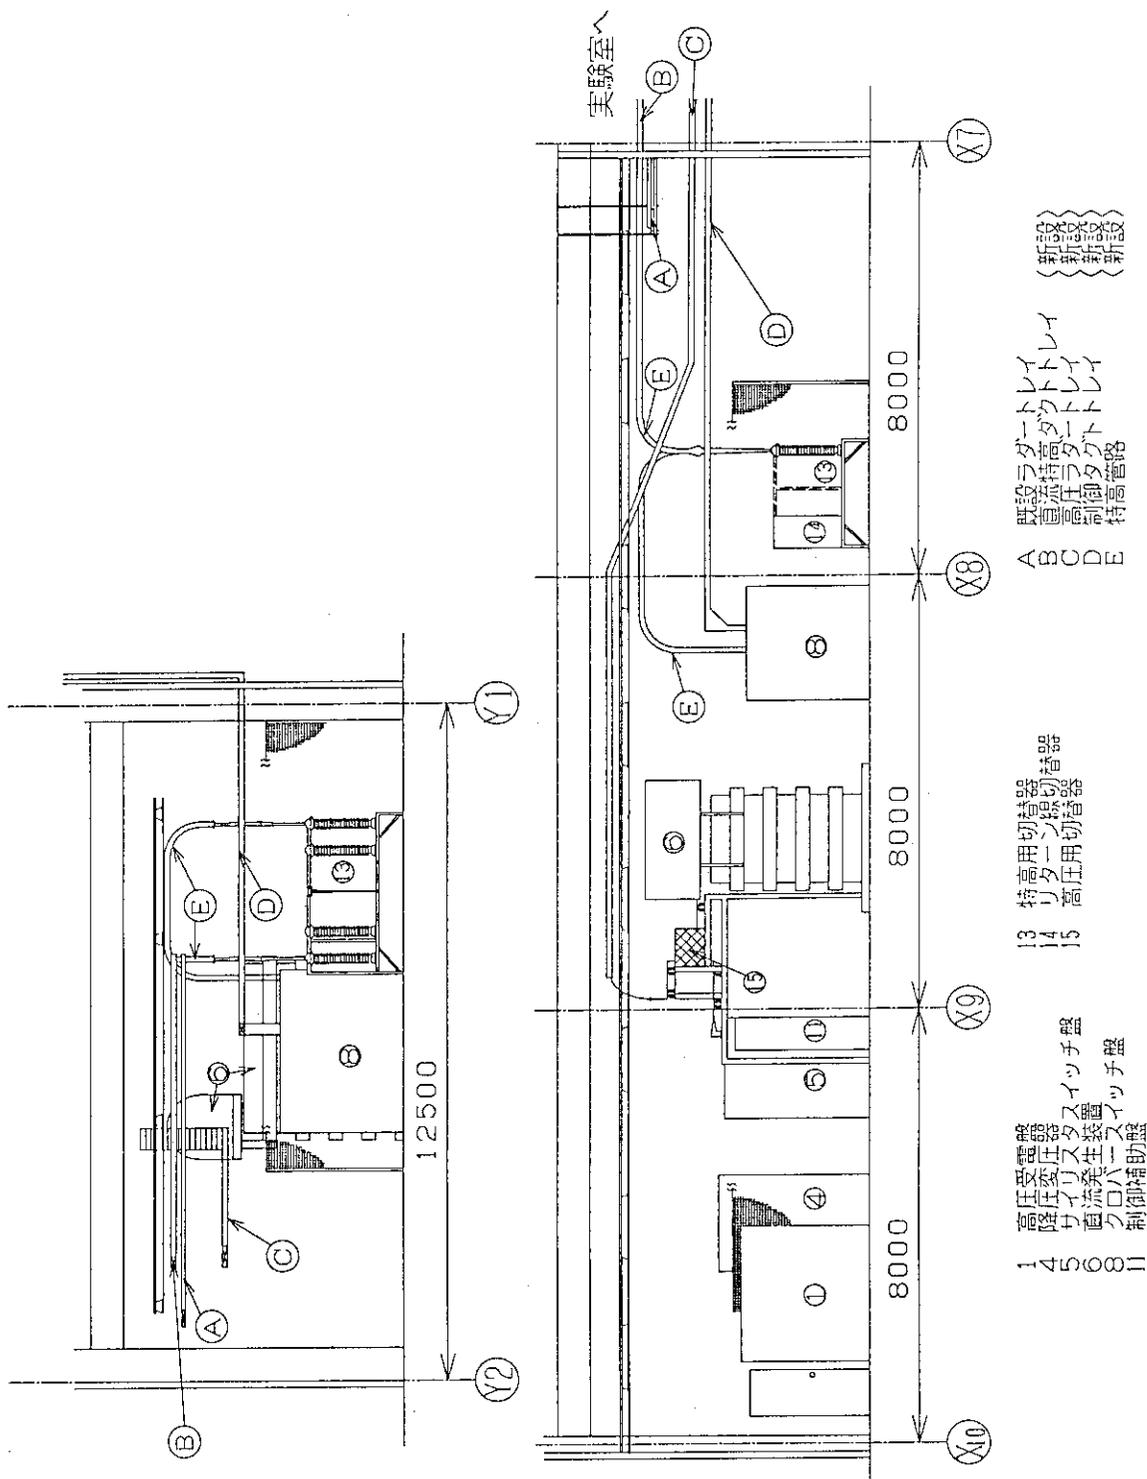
高周波工学試験装置電願配置図 (立面図)
